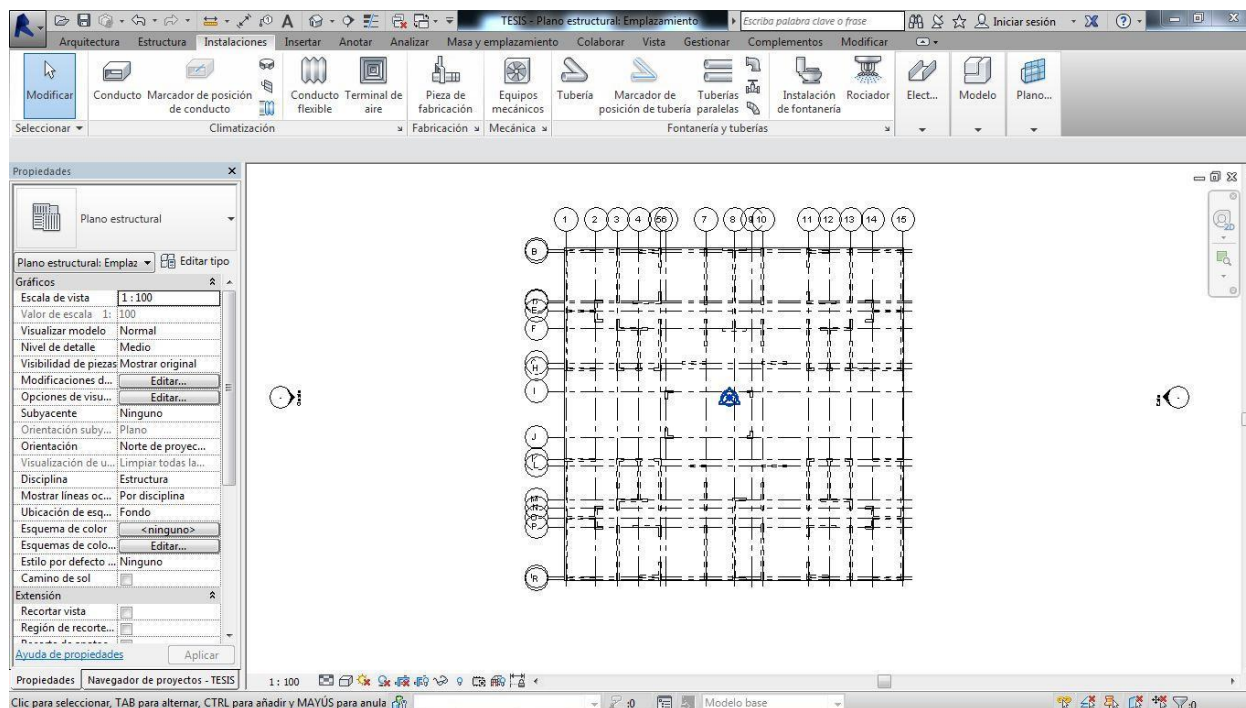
Plantilla del plano en 2D de la torre tipo A del proyecto en Autodesk Revit®.
